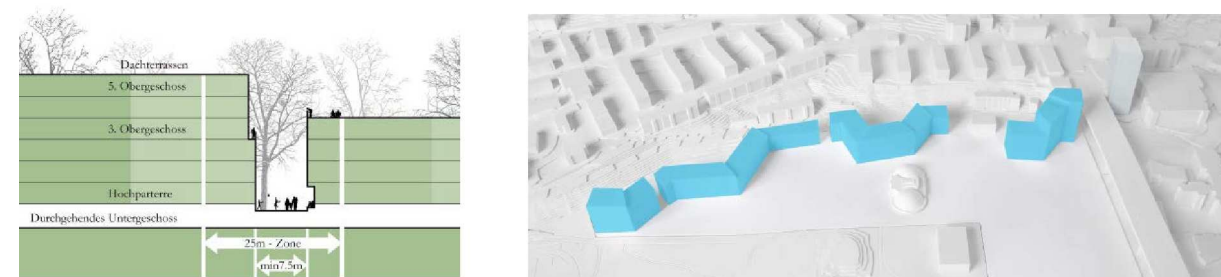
Illustration zu den Durchbrücken, einer denkbaren Bebauungsvariante und möglichen Gebäudetypen (Quelle: Schlussabgabe Team Harry Gugger Studio)
